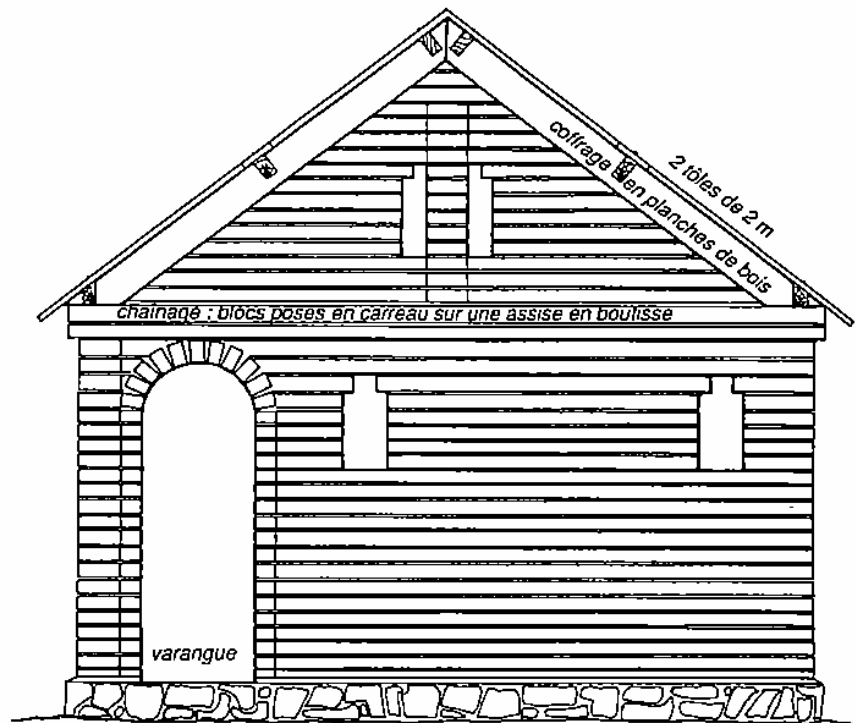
Façade du pignon. Noter le renfort vertical par un poteau appareillé.
